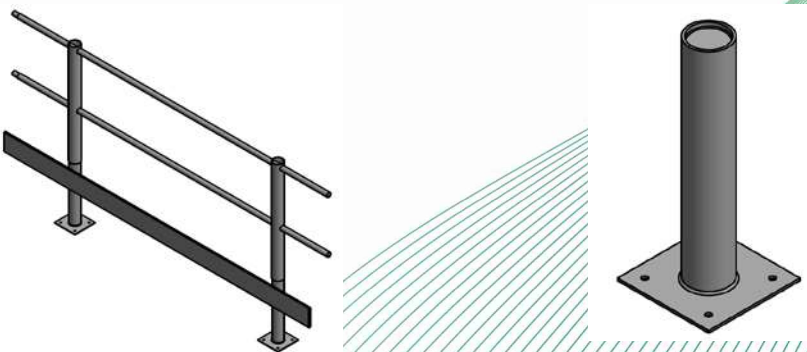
Fuß-Ausführungen Stehfalz Klasse B, zur Montage auf Stehfalzuntergründen
